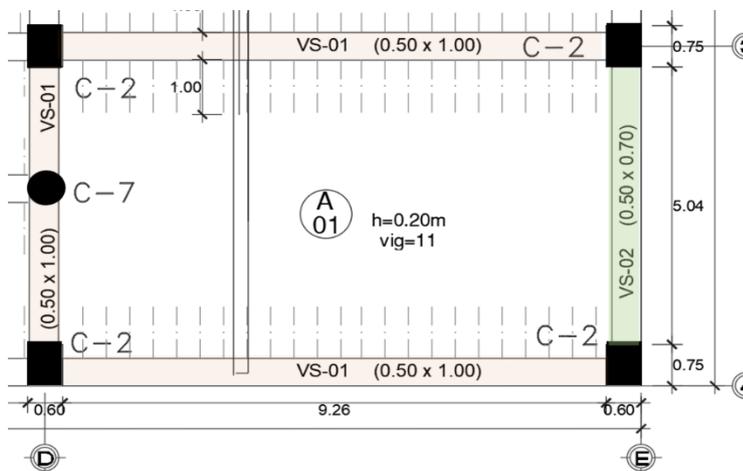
Diseño de Losas, Ver plano E01_Plano de Estructuras de Biblioteca, Elaboración propia.
